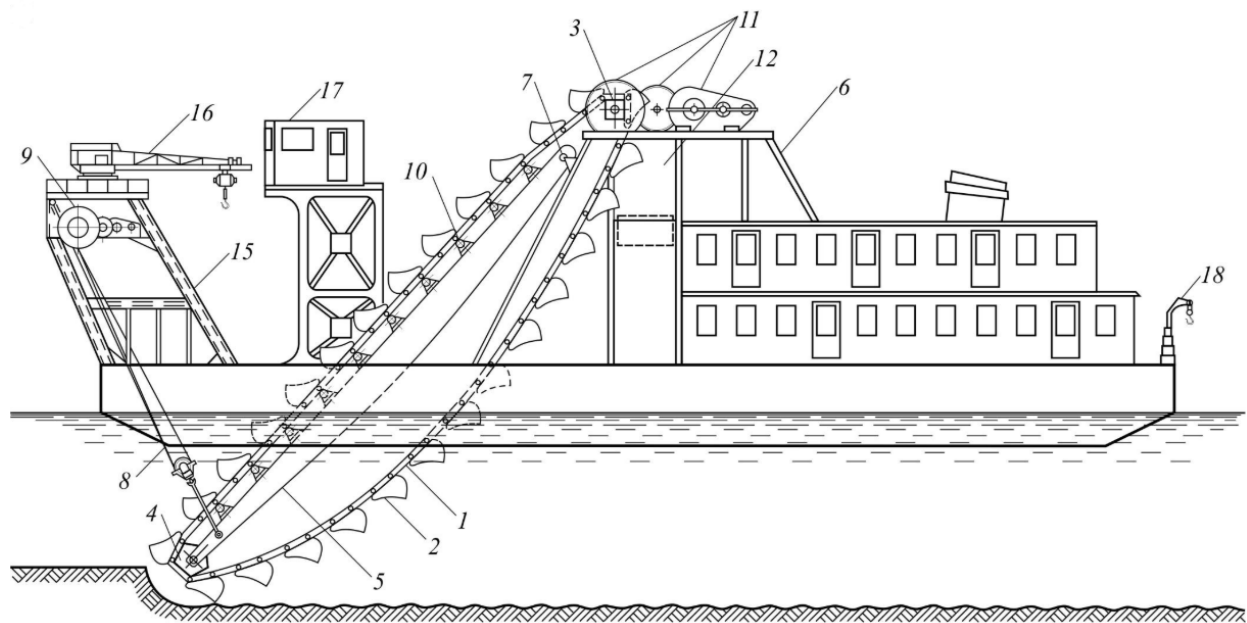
Схема багаточерпакового снаряда: 1 – черпаковий ланцюг; 2 – черпак; 3 – верхній барабан; 4 – нижній барабан; 5 – черпакова рама; 6 – черпакова вежа; 7 – підшипник підвісу; 8 – рамопідйомний трос; 9 – рамопідйомна лебідка; 10 – роликовий схил; 11 – черпаковий привід; 12 – ґрунтова криниця; 13 – розподільний клапан; 14 – ґрунтовий лоток; 15 – підйомна станина (копер); 16 – кран; 17 – пост управління; 18 – кран-балка.
